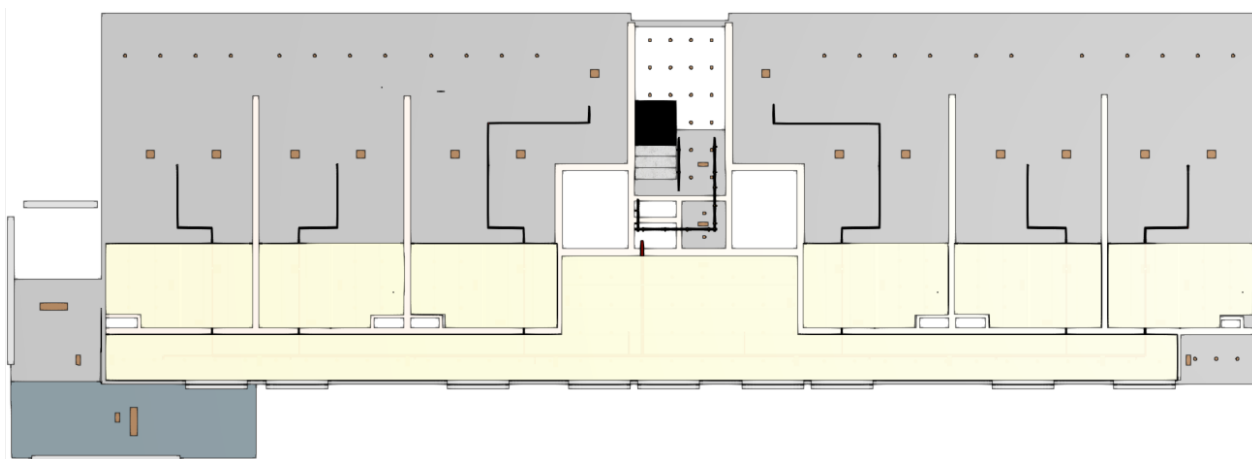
Vista della pianta del soffitto (Open BIM Layout)
